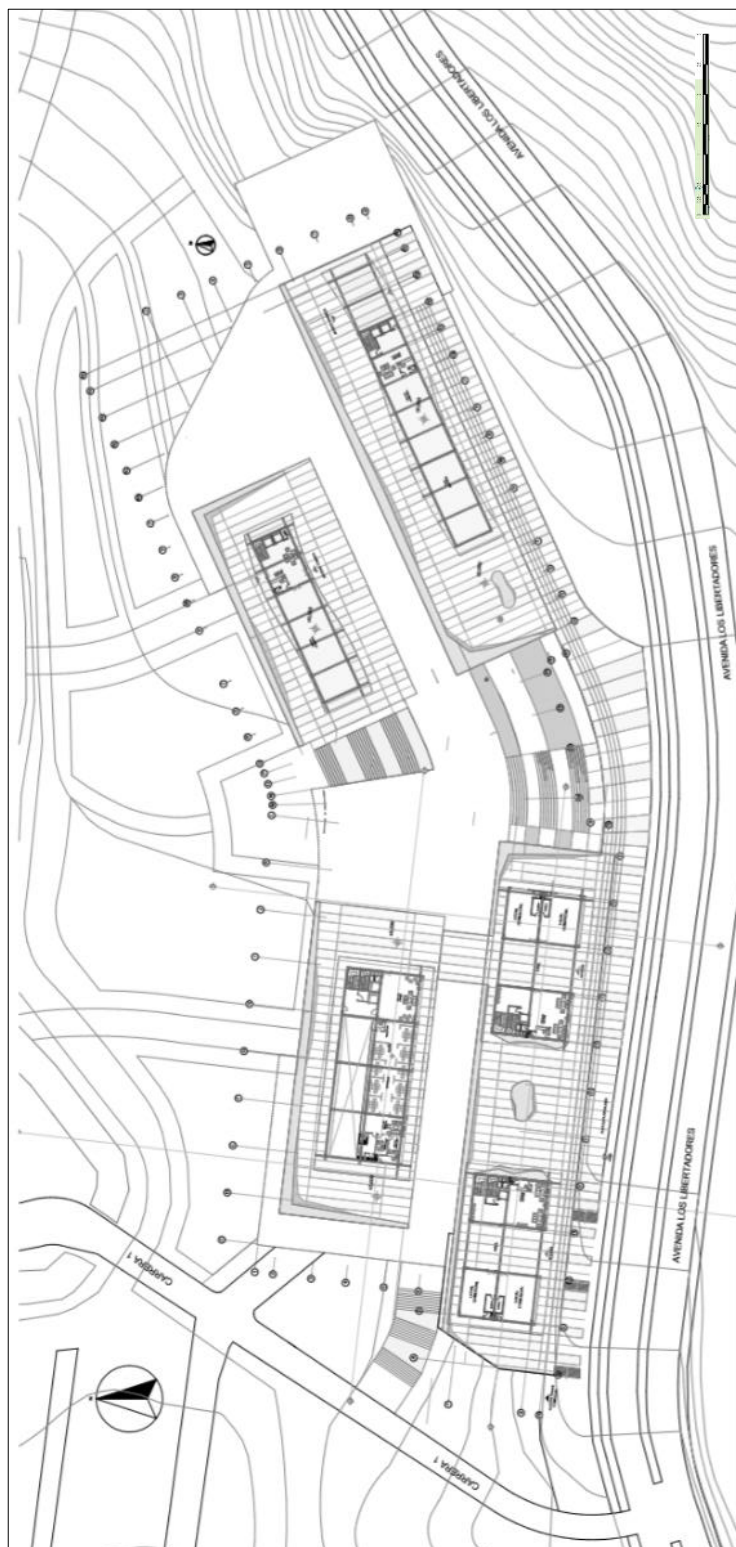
Planta arquitectónica nivel 0,0 planta libre
